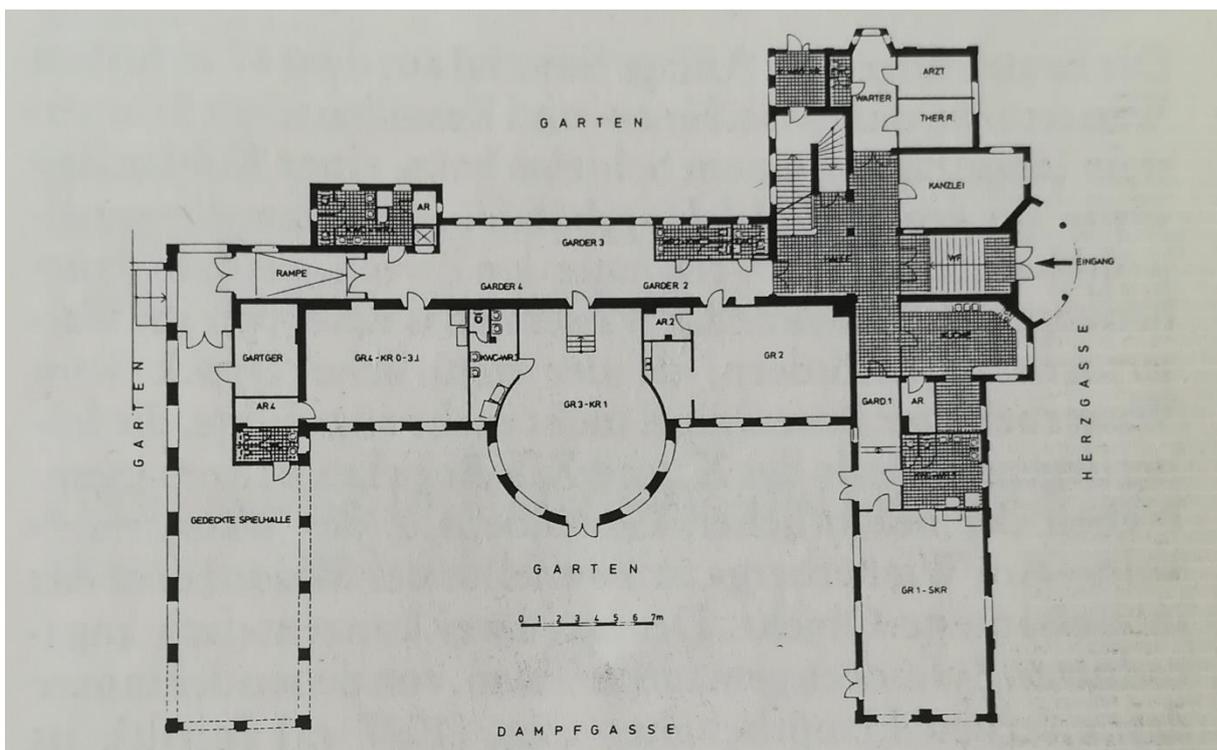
Jahr 1986 - Grundriss von der Magistratsabteilung 19 zur Sanierung des Kindergartens - Erdgeschoss
